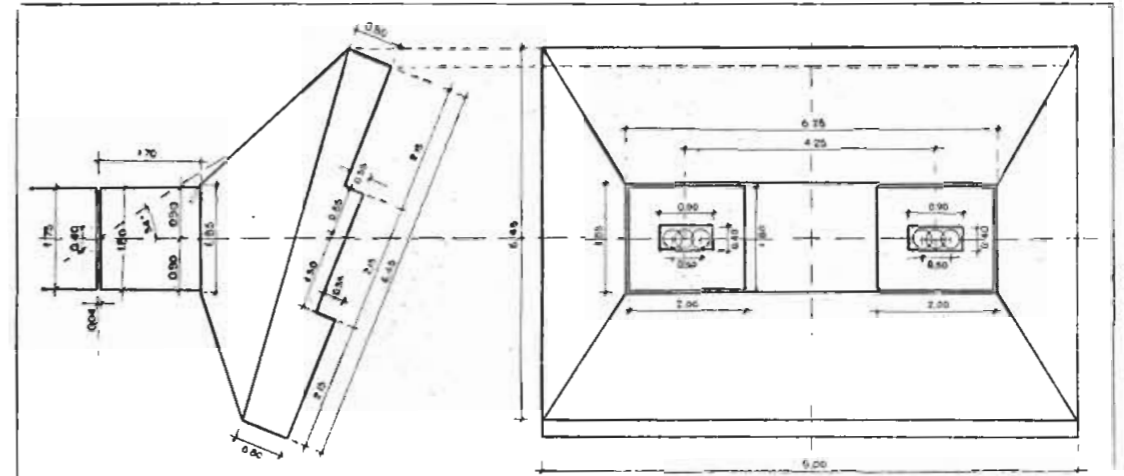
BASE II (MARGEN DE COPETONAS) CONSTITUIDA POR UN MACIZO TRONCO-PIRAMIDAL DE HORMIGÓN ARMADO
